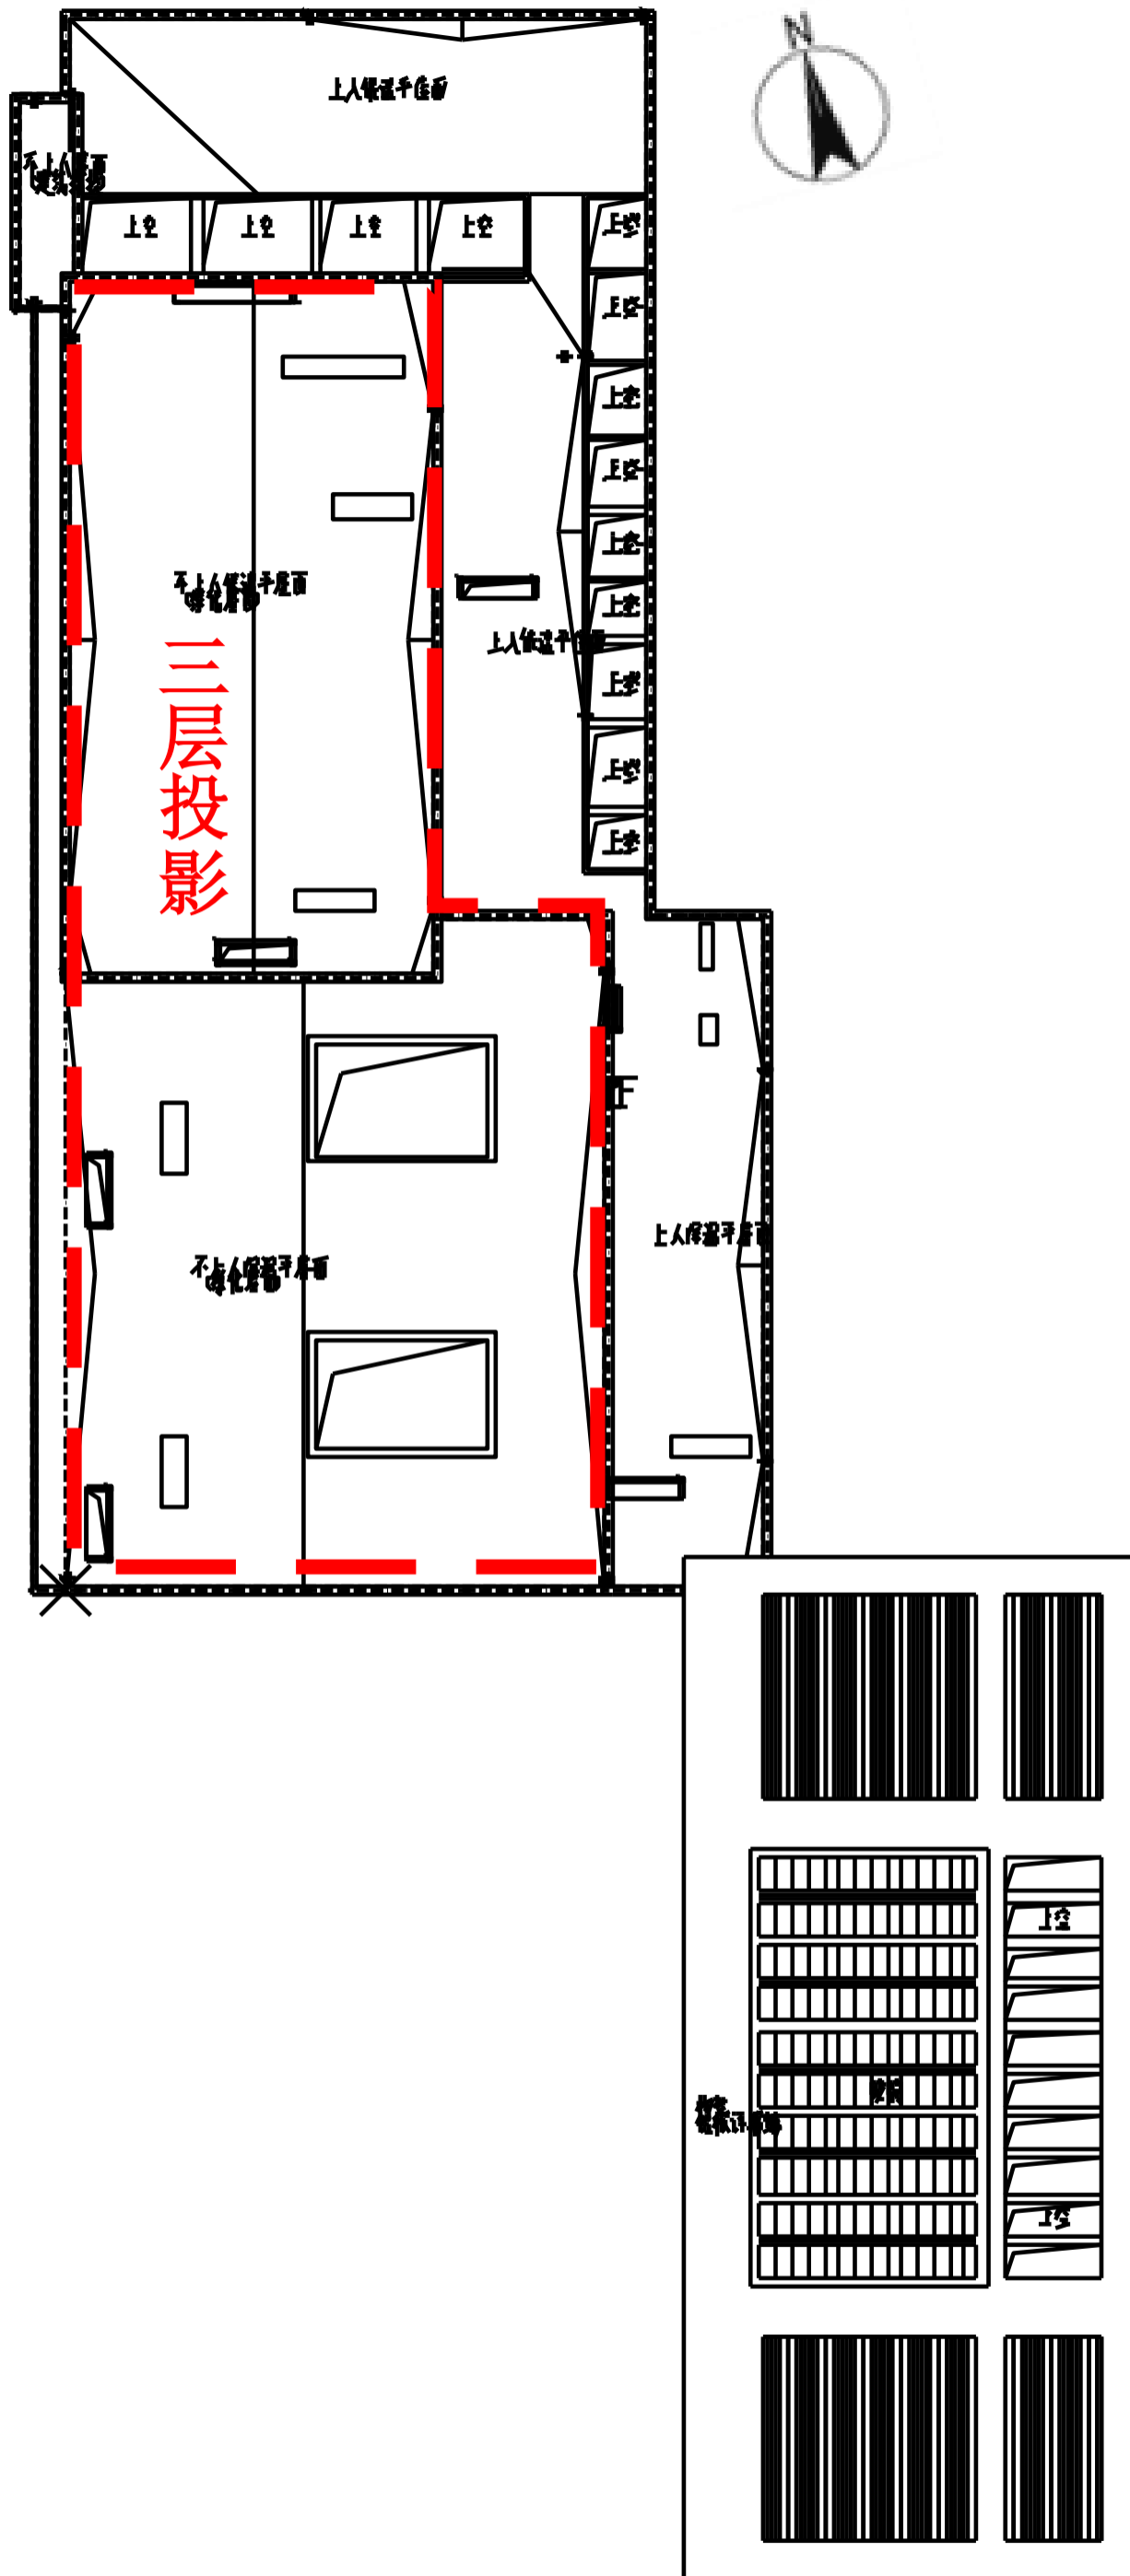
重离子质子中心屋顶层平面布置图
